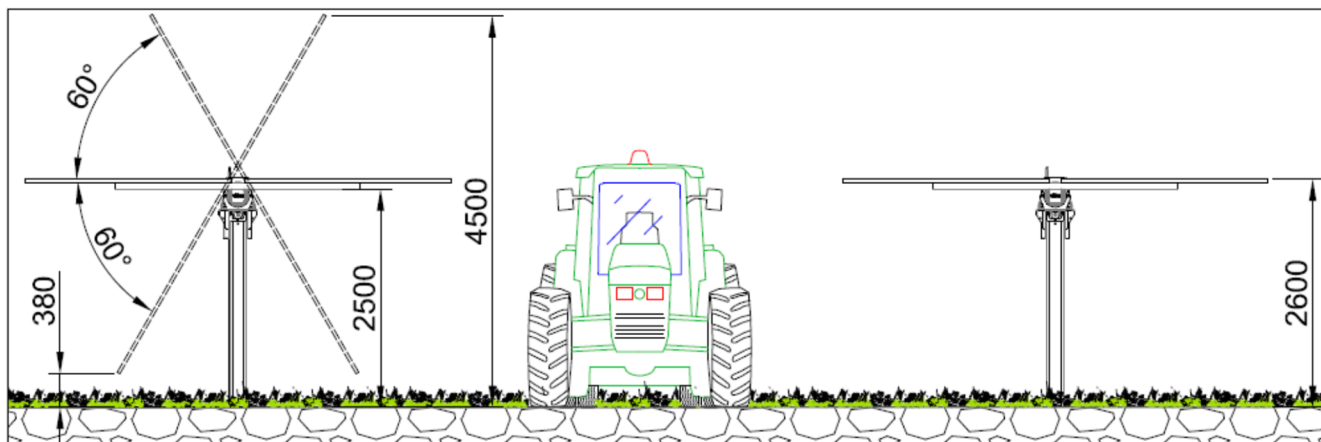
Schema della struttura sezione longitudinale e altezze componenti
